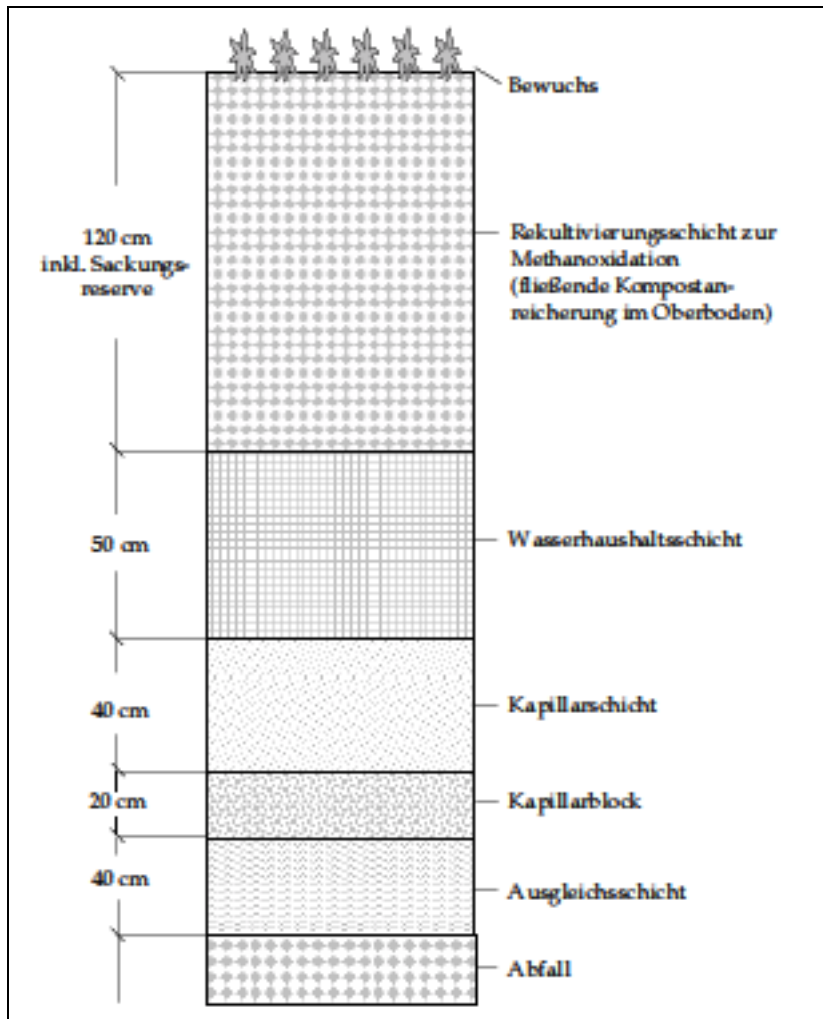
Aufbau einer Oberflächenabdichtung mit Kapillarsperre und Rekultivierungsschicht zur Methanoxidation (Jäger et al, 2008)
